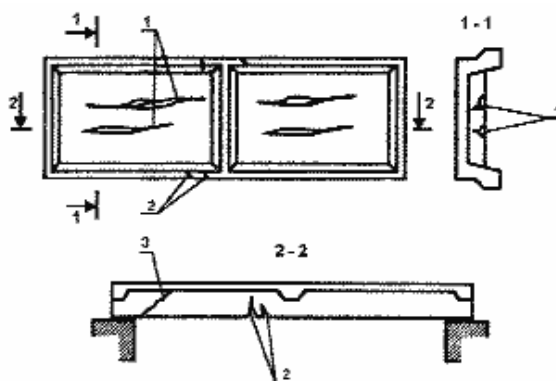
Силовые трещины на потолочной поверхности ребристой панели перекрытий; 1 — в полке панели; 2 — нормальные в продольном ребре; 3 — наклонные в продольном ребре; 4 — продольные в поперечном ребре
